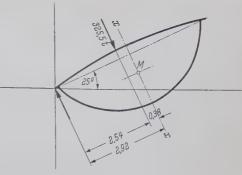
Querschnitt und Querschnittswerte der Fischbauchklappe
